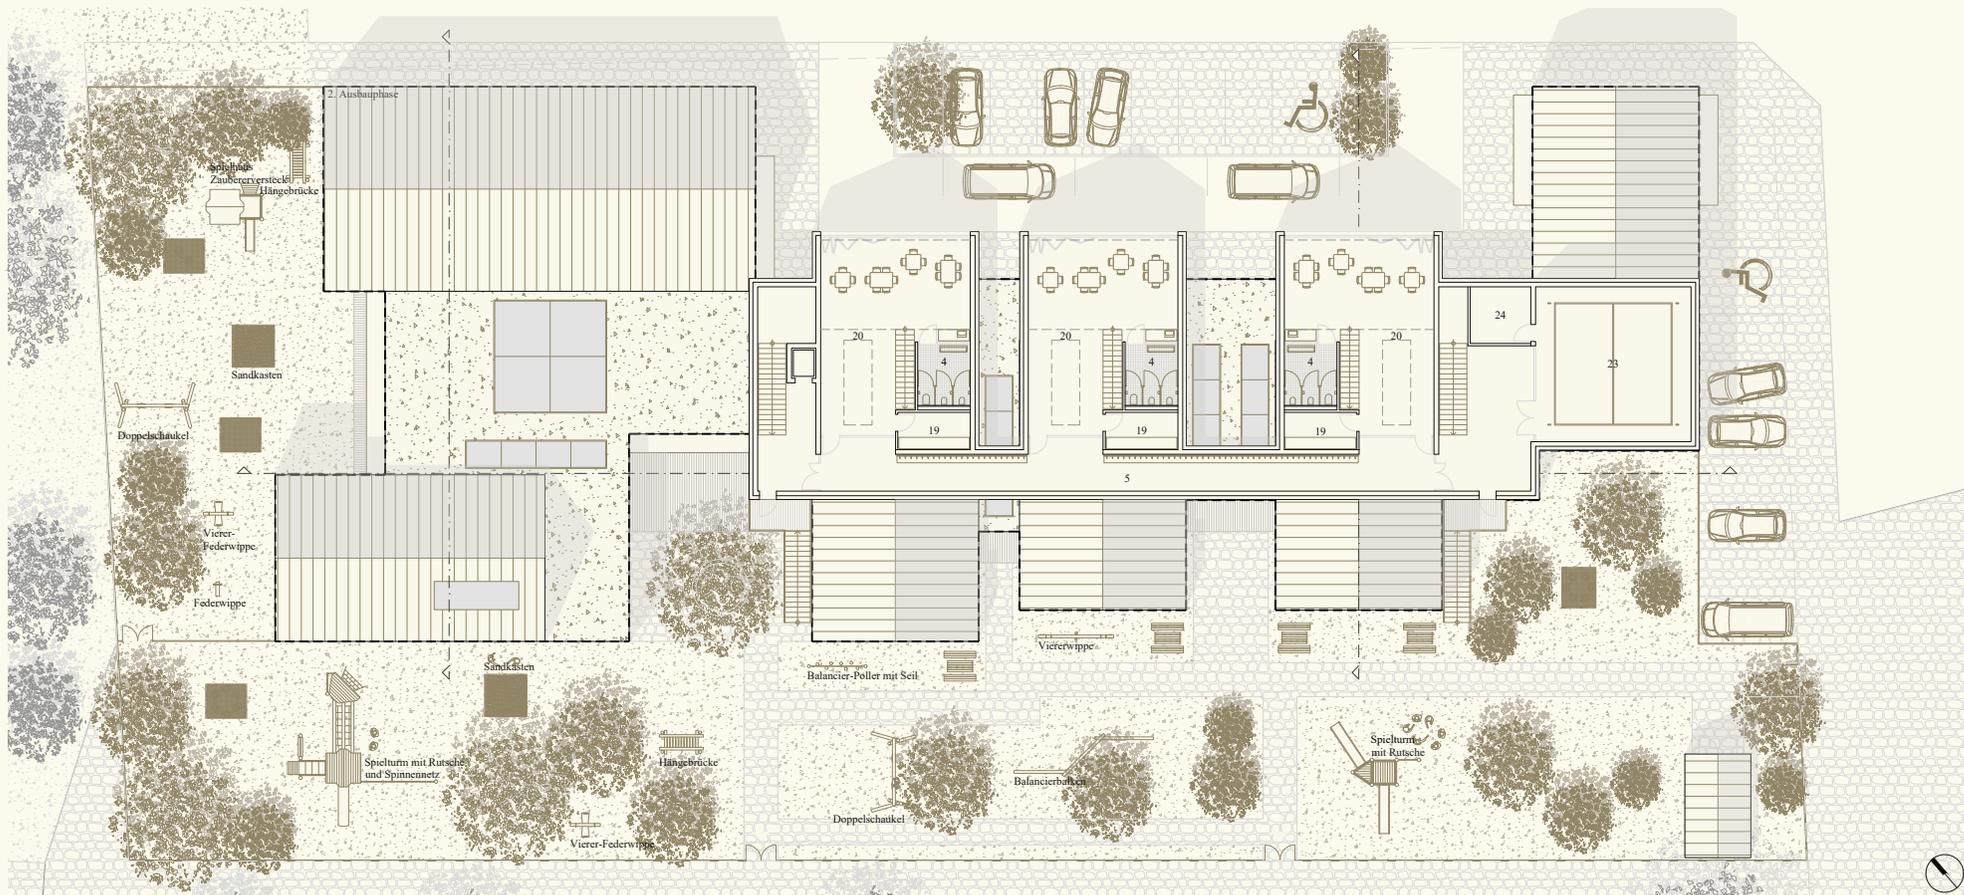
, Grundriss Obergeschoss | 1:400
